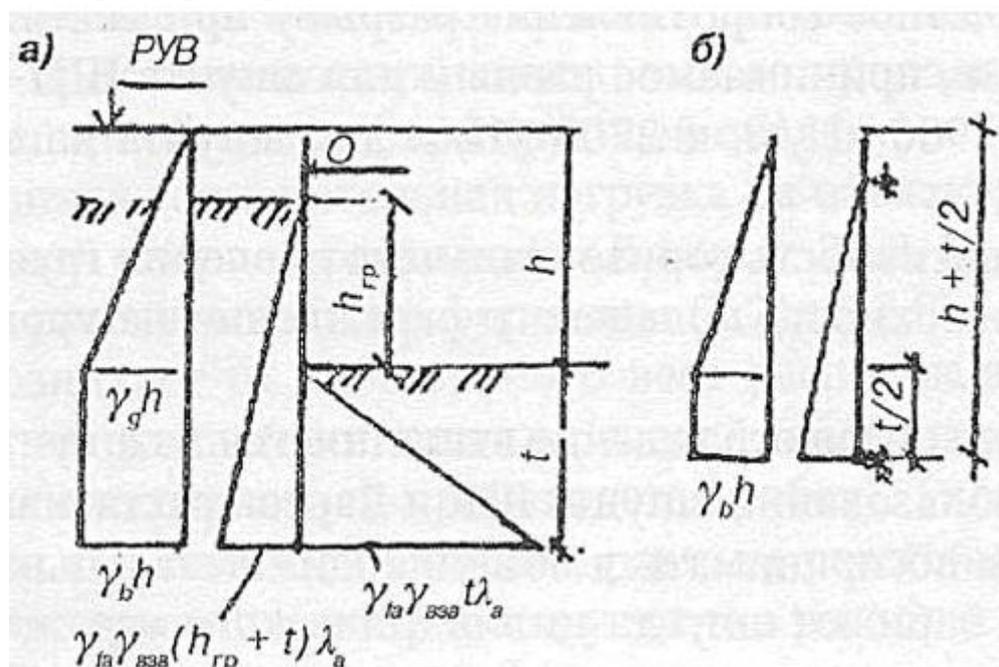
Схемы расчета шпунтовой стенки в песчаных и супесчаных грунтах при одном ярусе креплений: а – при определении минимальной глубины забивки шпунта; б – при проверке прочности стенки, внутренней обвязки и распорок
